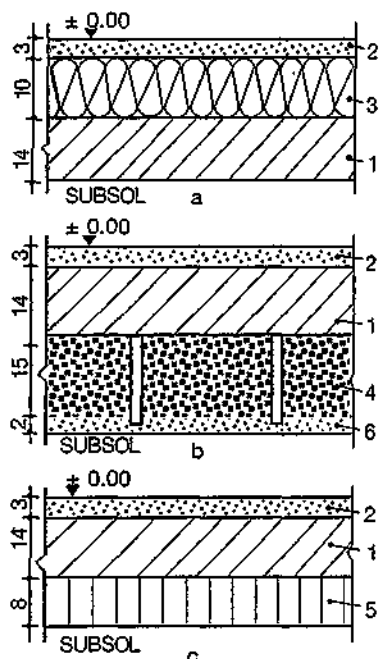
Alcătuirii de planșee peste pivnițe și subsoluri neîncălzite:
